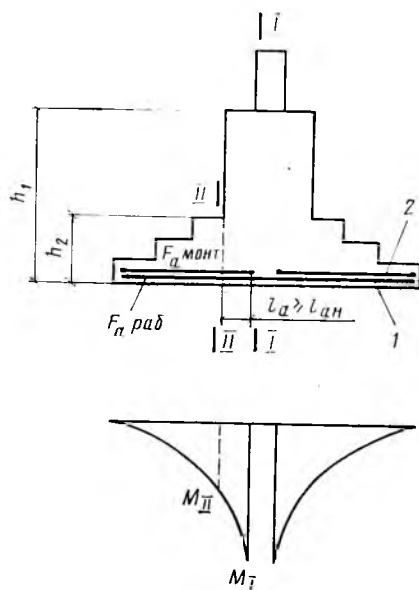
К расчету фундаментов с учетом монтажной арматуры сеток другого слоя I — сетки 1-го слоя; 2 — сетки 2-го слоя
